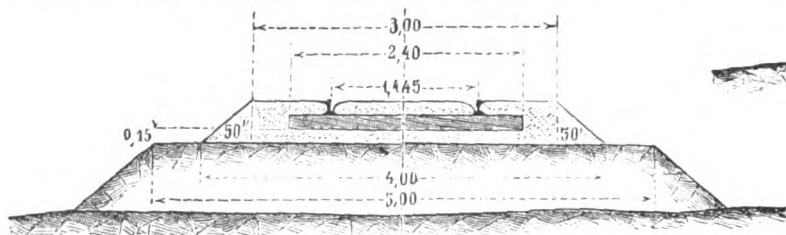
Billige Regelspur II mit eigenen Fahrzeugen. Einschnitt mit freier Bettung.
